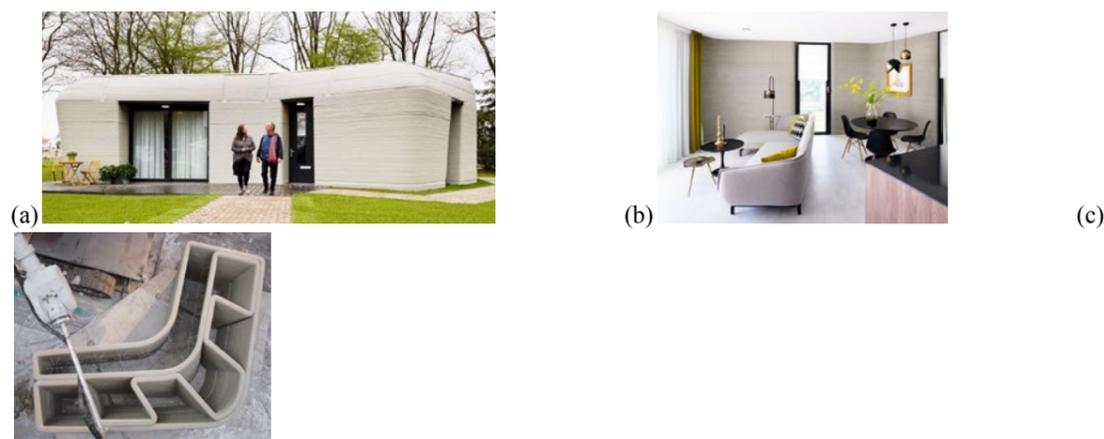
Exterior (a) e interior (b) da casa e (c) parte da parede. Fonte: 3D PRINTED HOUSE (2023).
